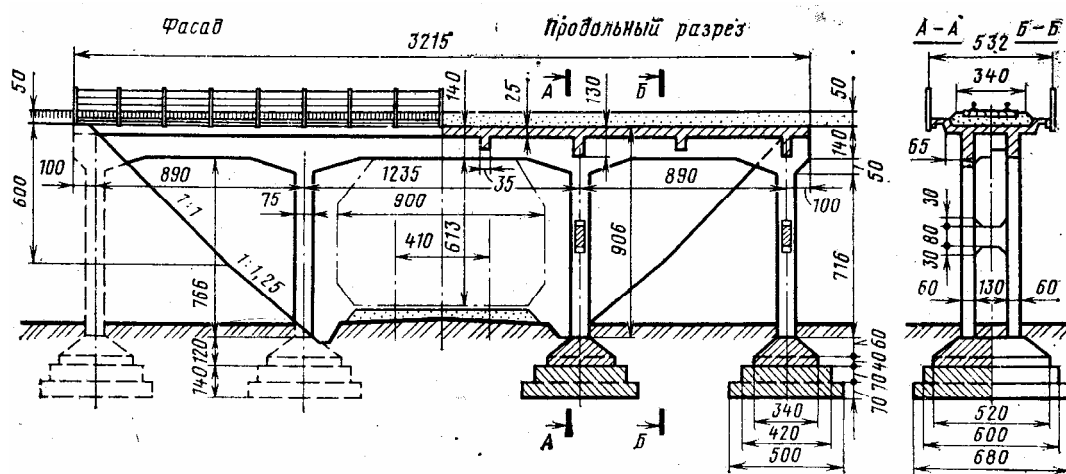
Конструкция рамного путепровода из монолитного железобетона
